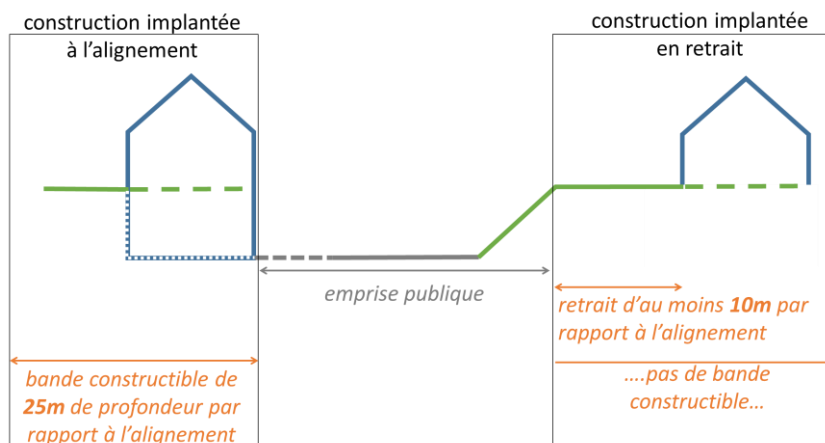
Illustration – règles d'implantation pour les terrains bordés par des talus faisant l'objet de dispositions particulières
